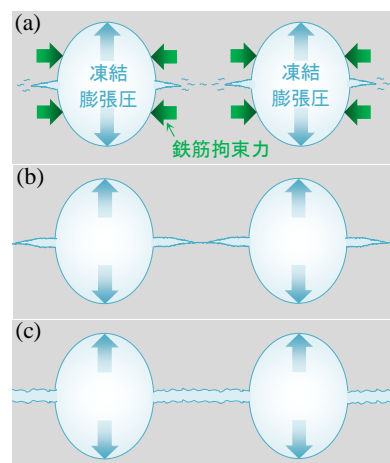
水平方向の微細ひび割れが水平ひび割れに成長
